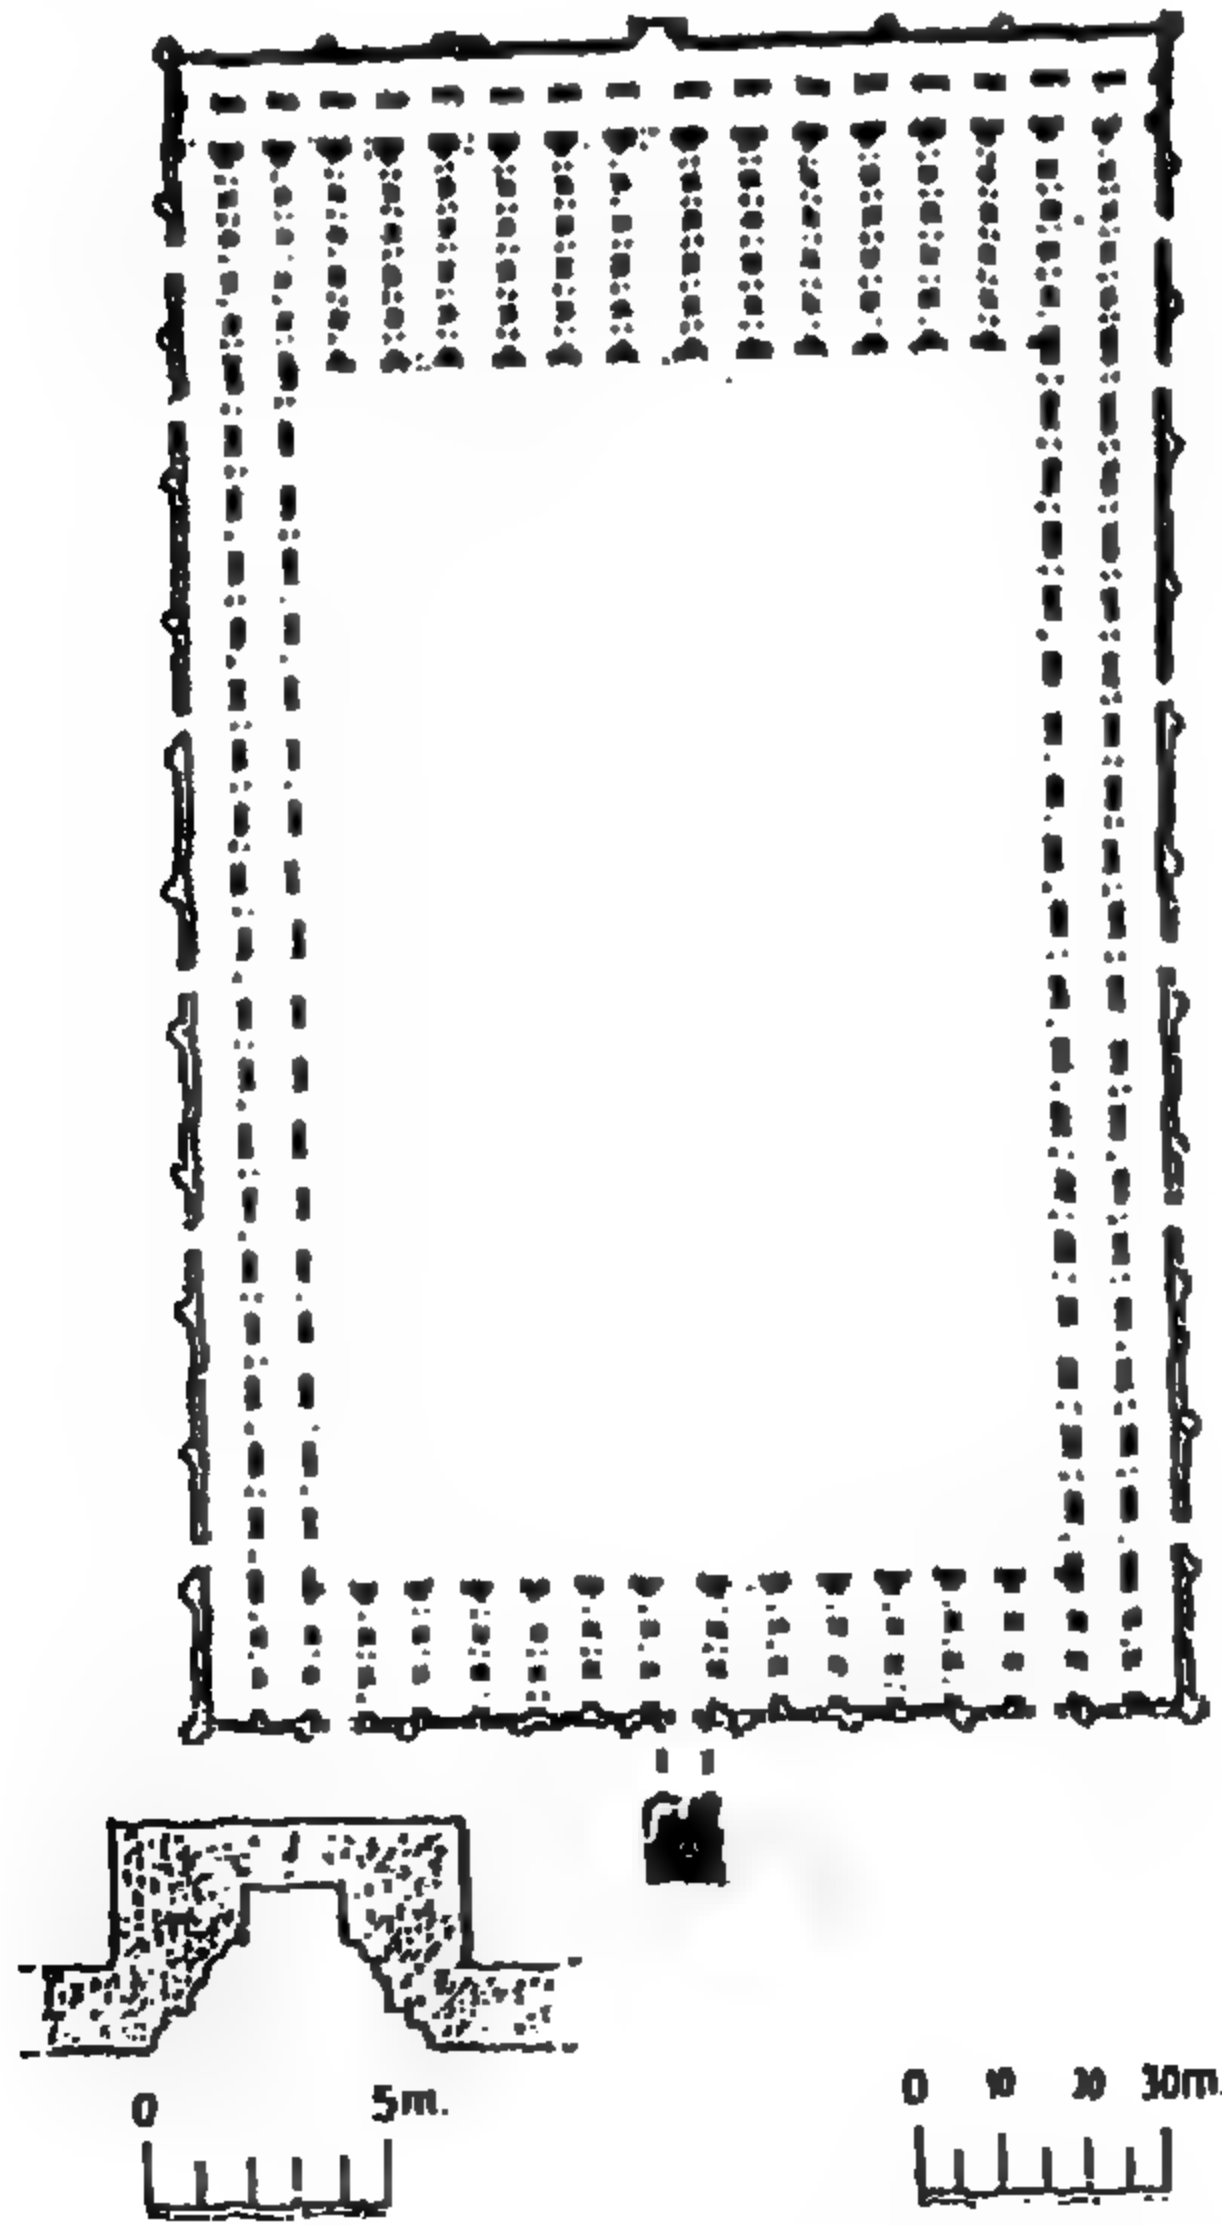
مسقط أفقي لجامع سامرا الكبير (عن : Creswell)
